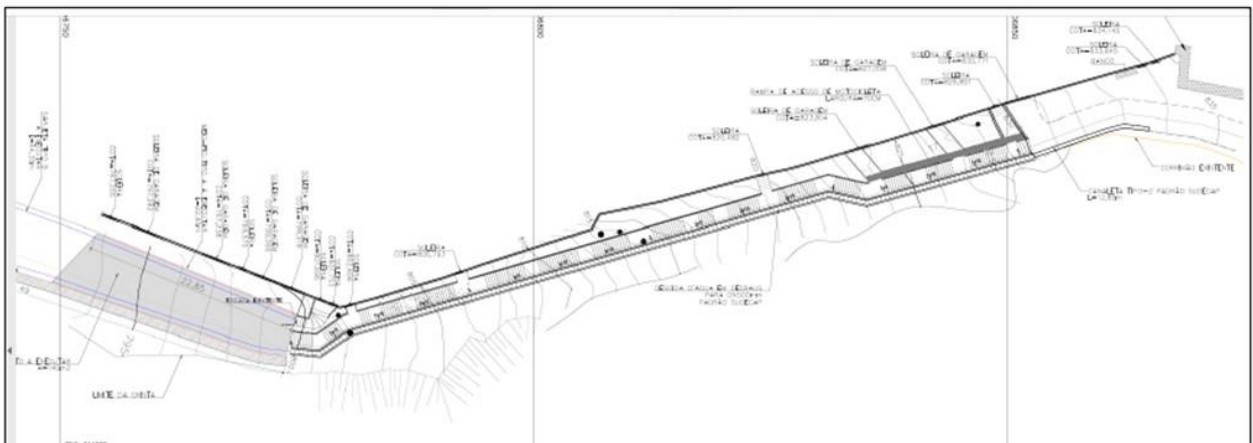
Planta baixa do projeto de escadaria e escada hidráulica. Fonte: RAP/SUDECAP.
